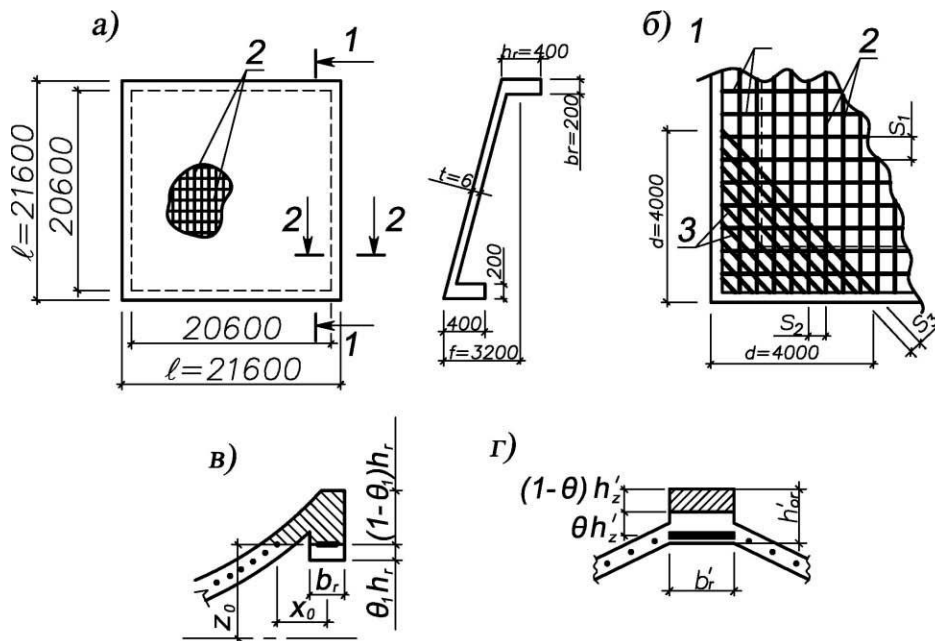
Схема армирования гипара: а - общий вид, б - армирование нижнего угла, в – примыкание оболочки к бортовому ребру, г – то же, к коньковому ребру; 1 - арматура ребра, 2 – арматура поля оболочки, 3 – арматура угловой зоны
